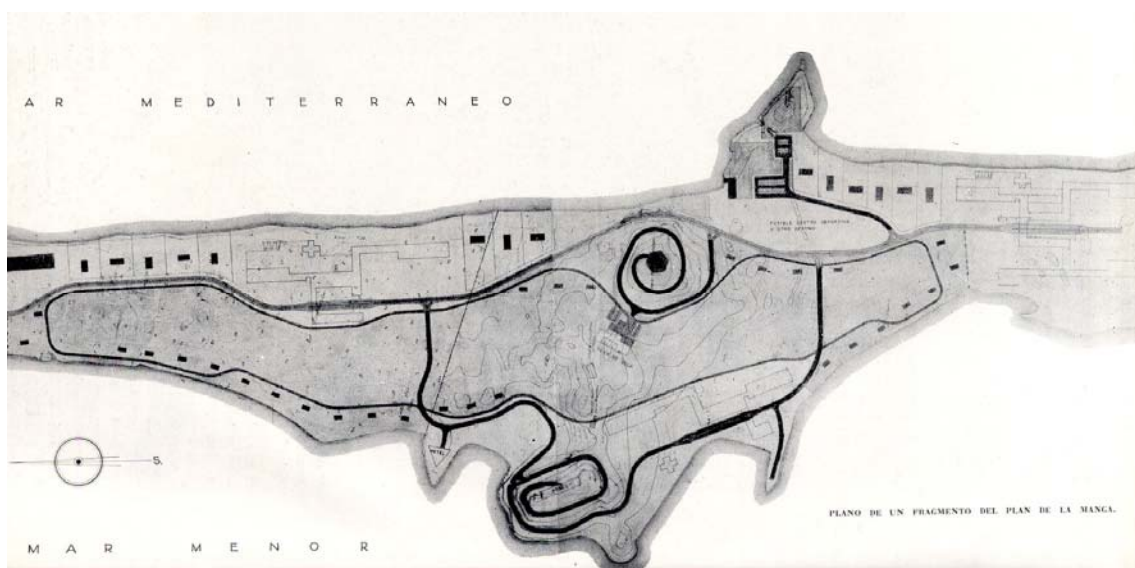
Fragmento de un plano original del plan inicial de La Manga (años 60). Fuente: COAC.
